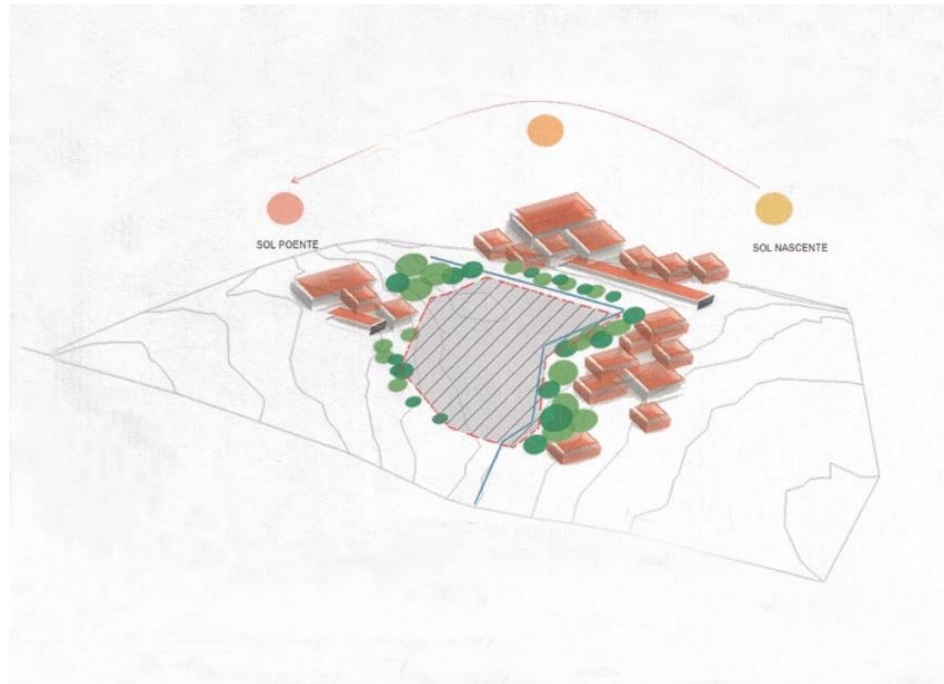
Planta baixa do Parque de Lazer e Eventos.
